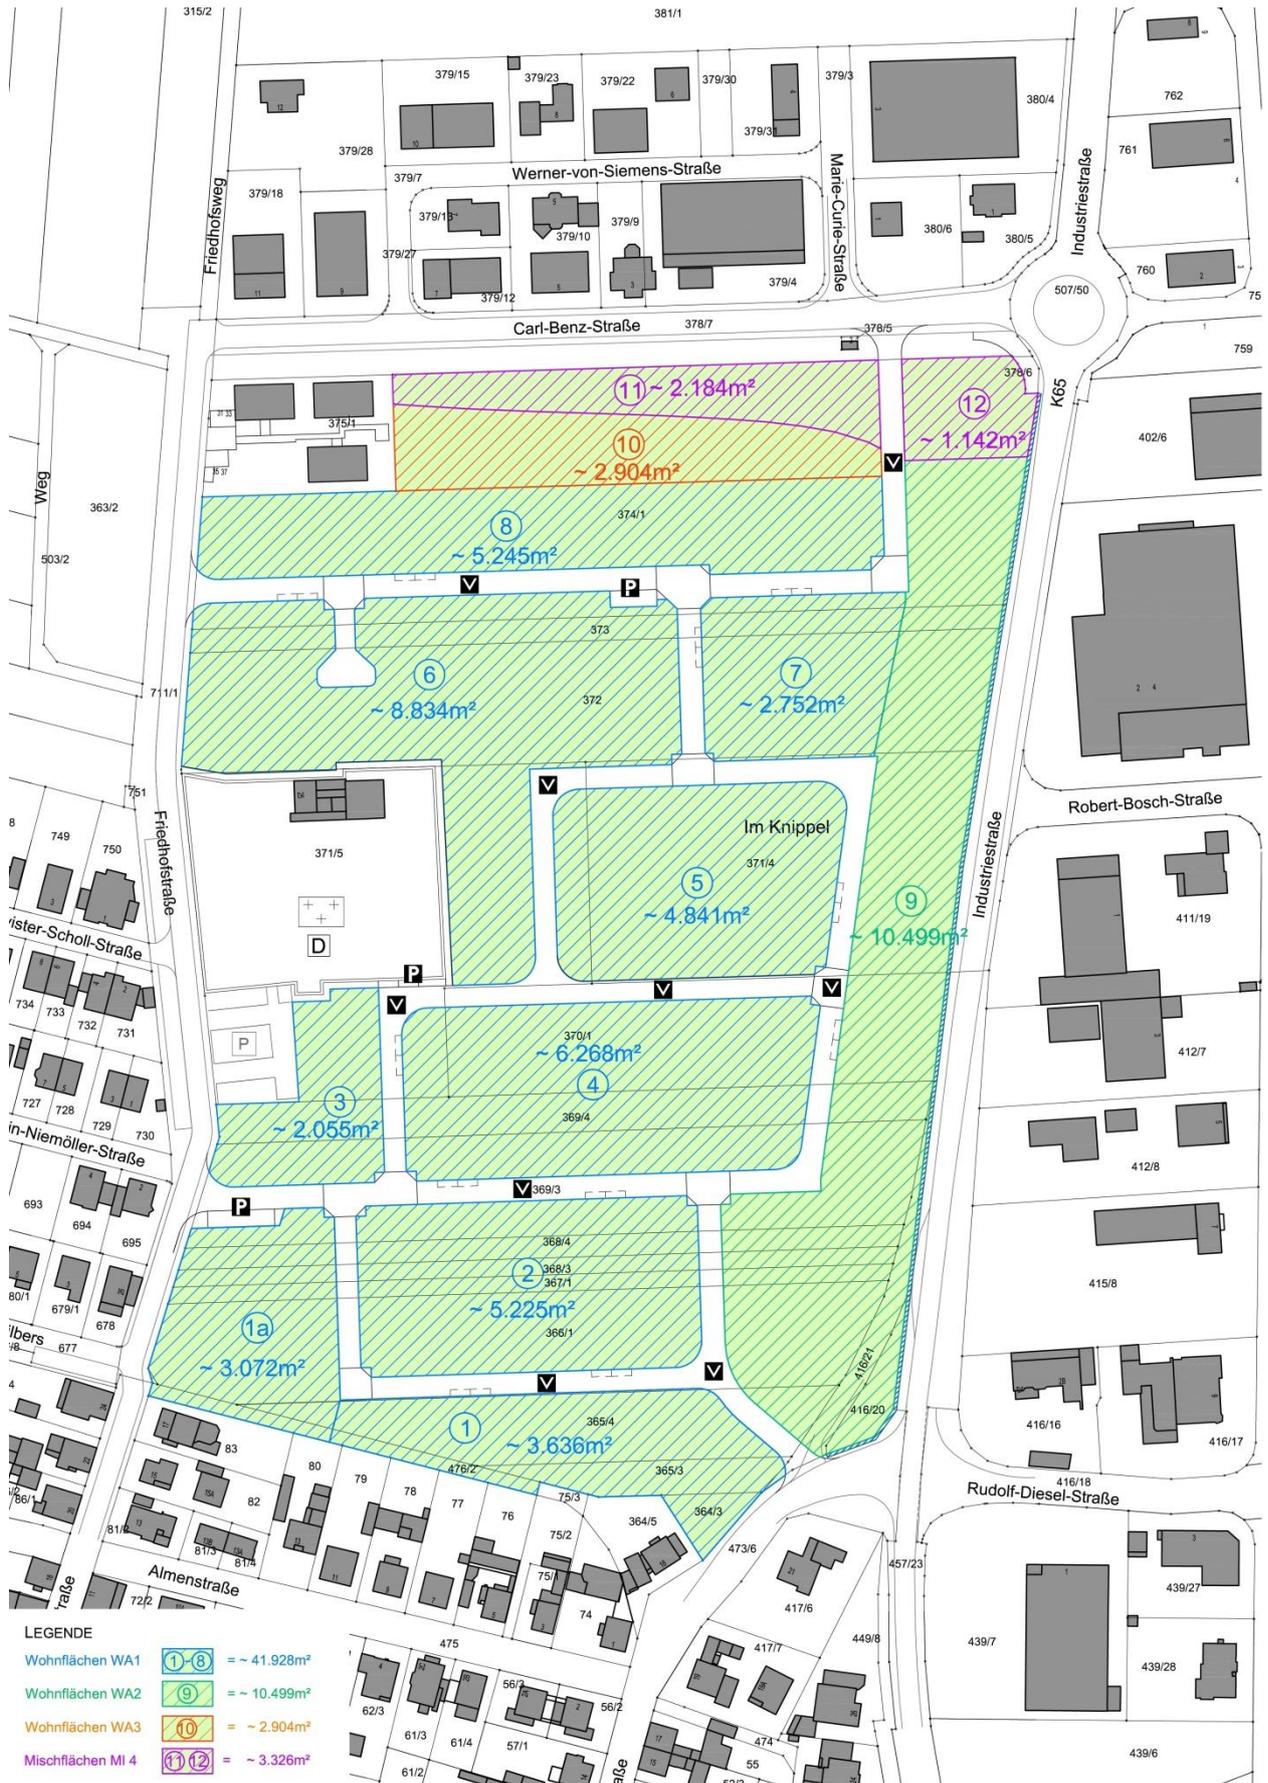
Darstellung der einzelnen Bauflächen mit Angabe zur jeweiligen Größe (unmaßstäblich)
